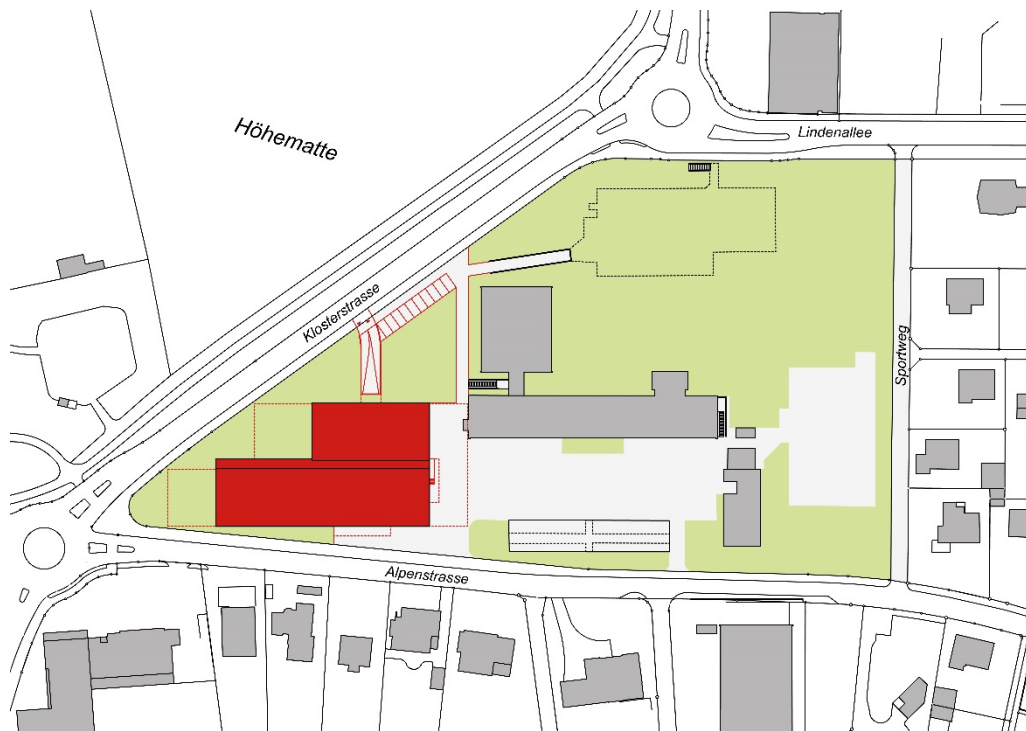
Situation Prüfung Machbarkeit unterirdische Parkierung
